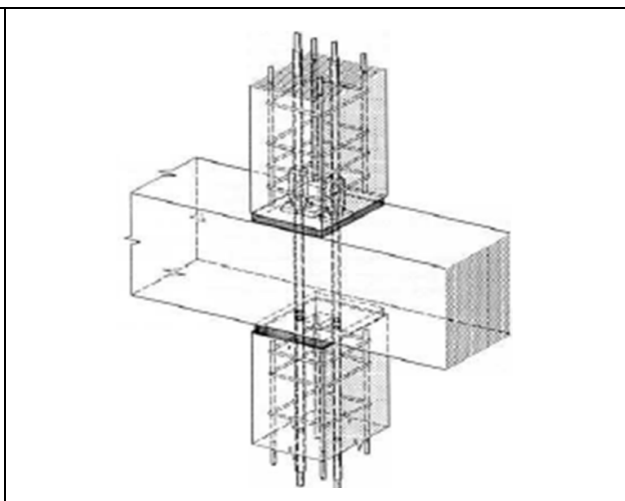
Interrupção de pilar com ligação por pré-esforço (Stupré, 1981)
